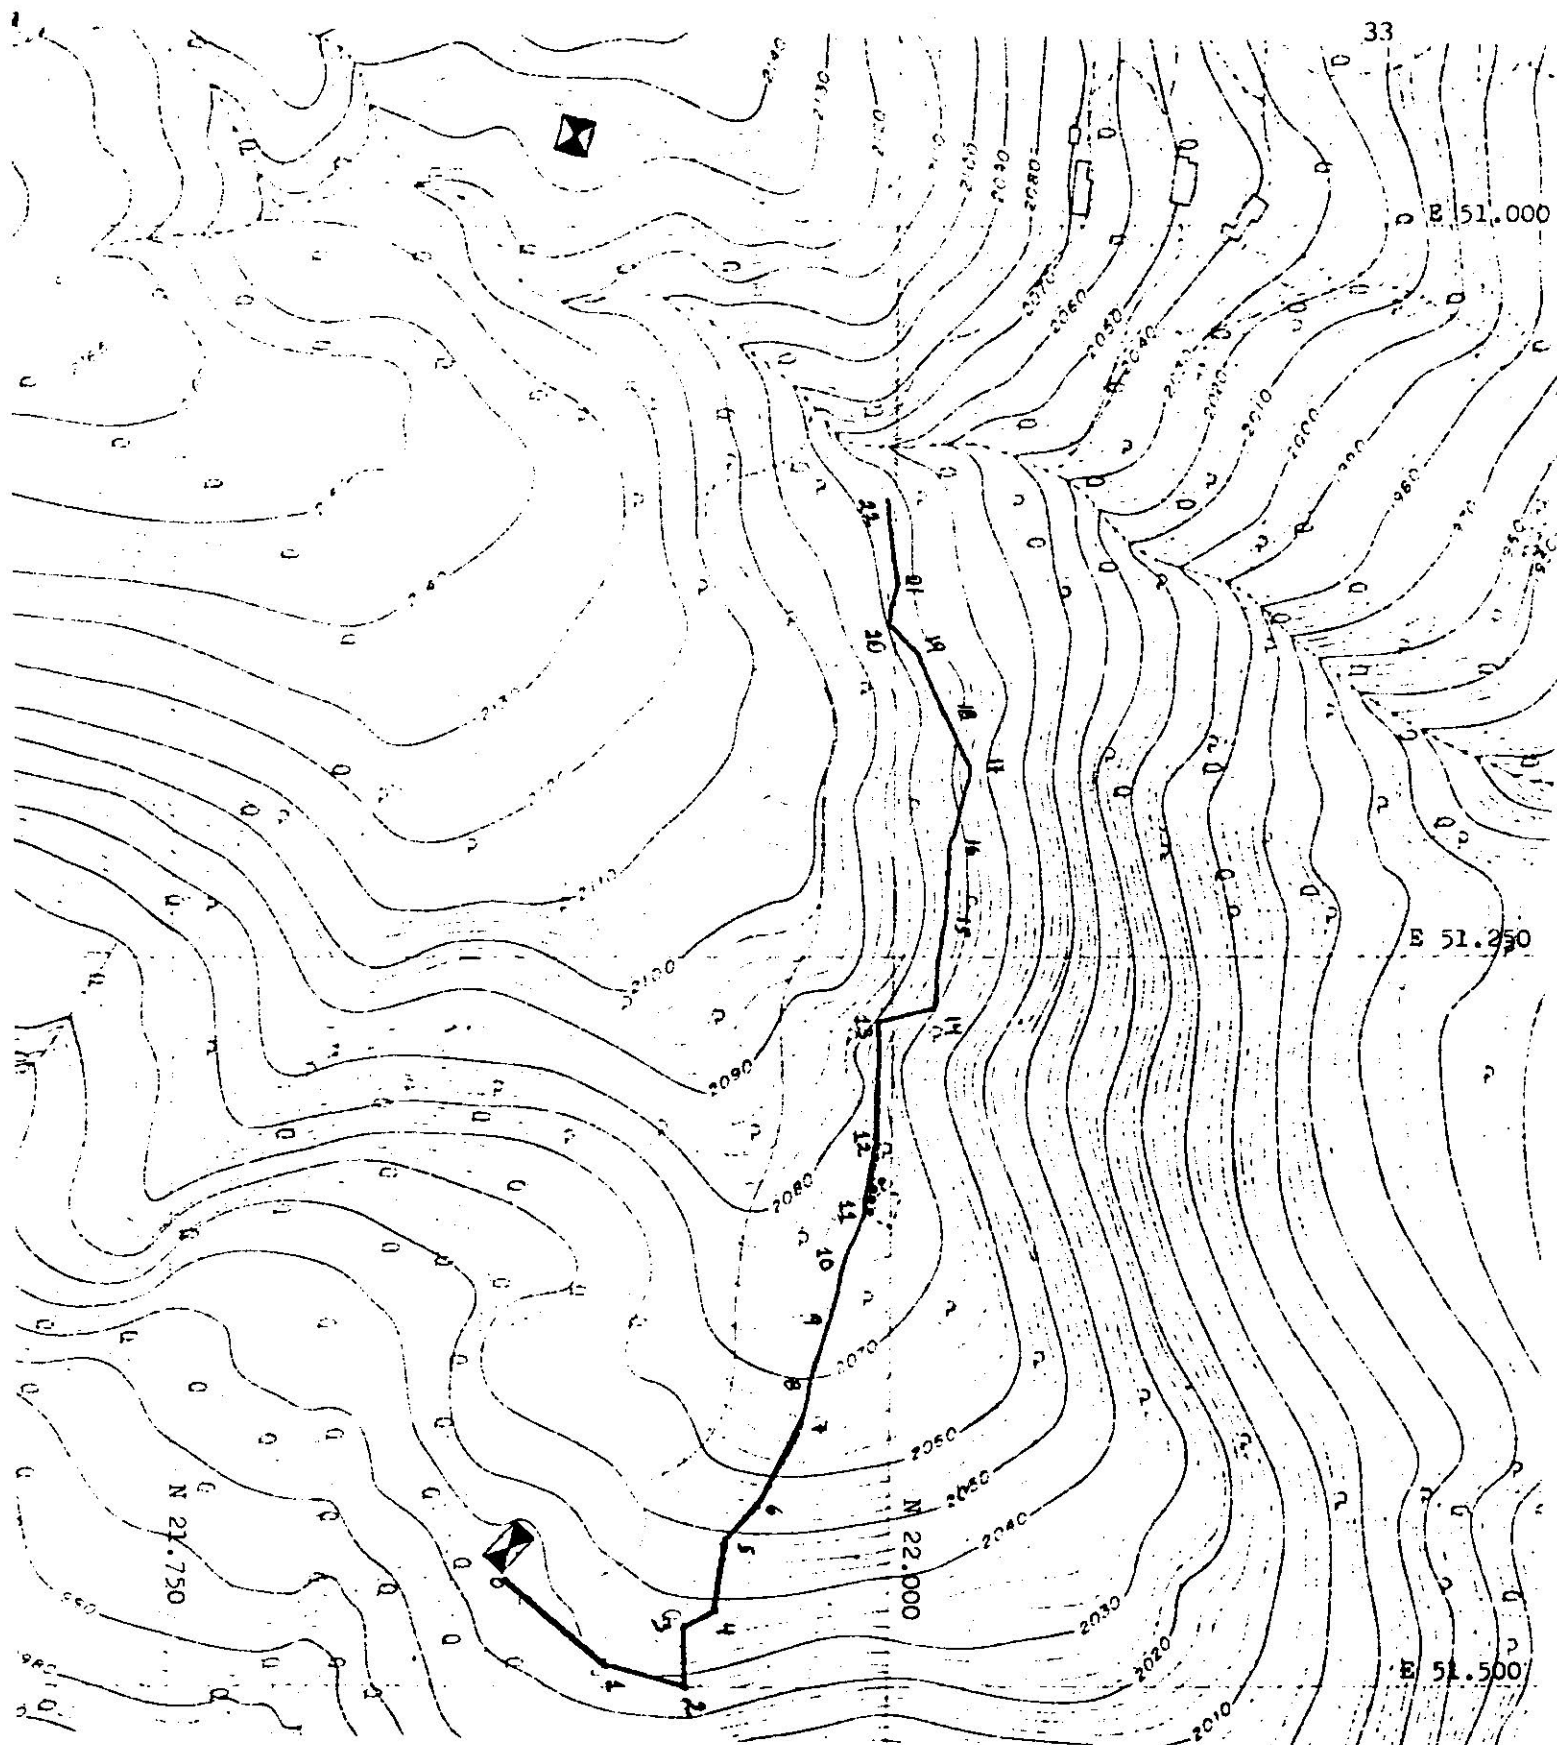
En el plano se aprecia la poligonal abierta y la ubicación de las cámaras subterráneas entre los puntos 11 y 12.
